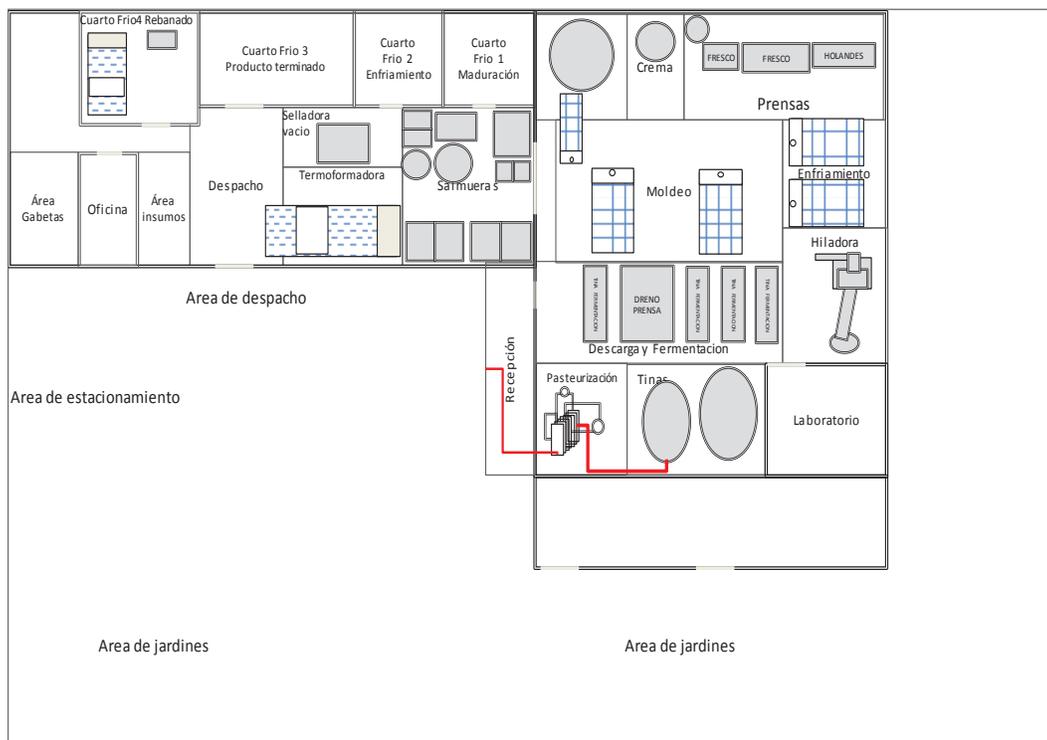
Layout de distribución de planta de Del campo Cía. Ltda., en el año 2013
